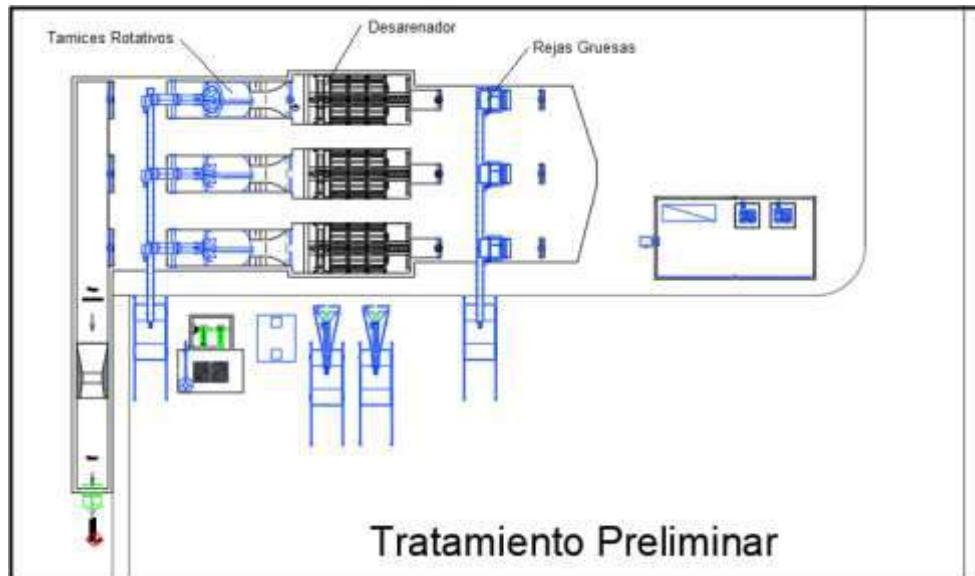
Disposición de implantación del Tratamiento Preliminar - Alternativa 3
